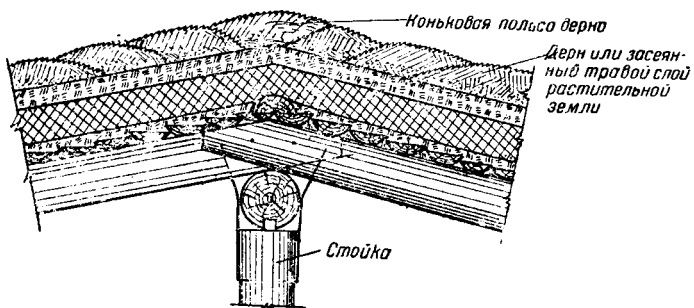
Кровли из грунто-материалов для покрытия землянок и полужемлянок
